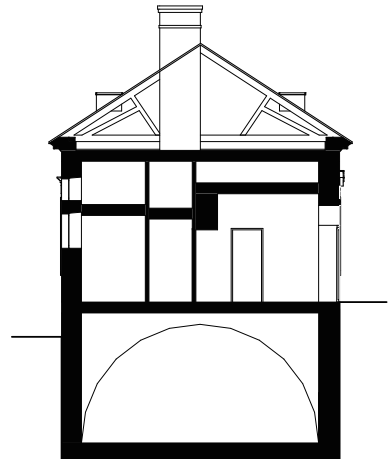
Bestandsplan Albertihaus, Querschnitt
